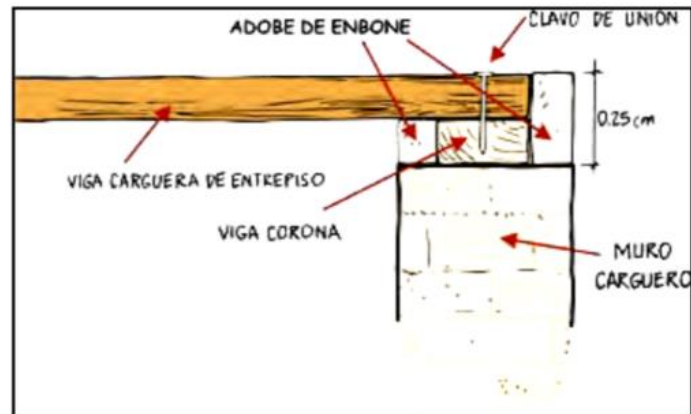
Unión correcta entre vigas de entepiso y viga corona sobre muro carguero de adobe.
